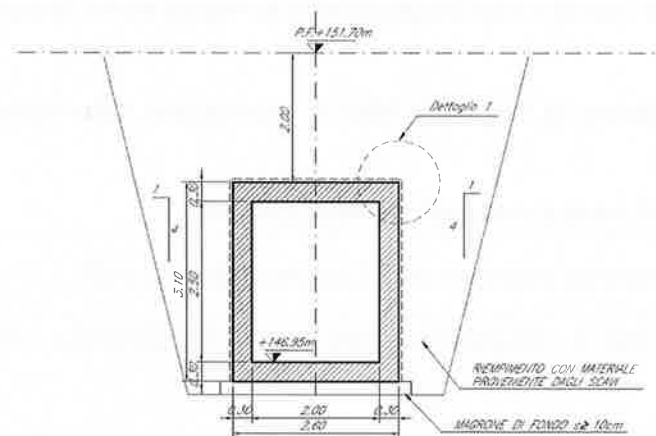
SEZIONE TRASVERSALE TIPOLOGICA
